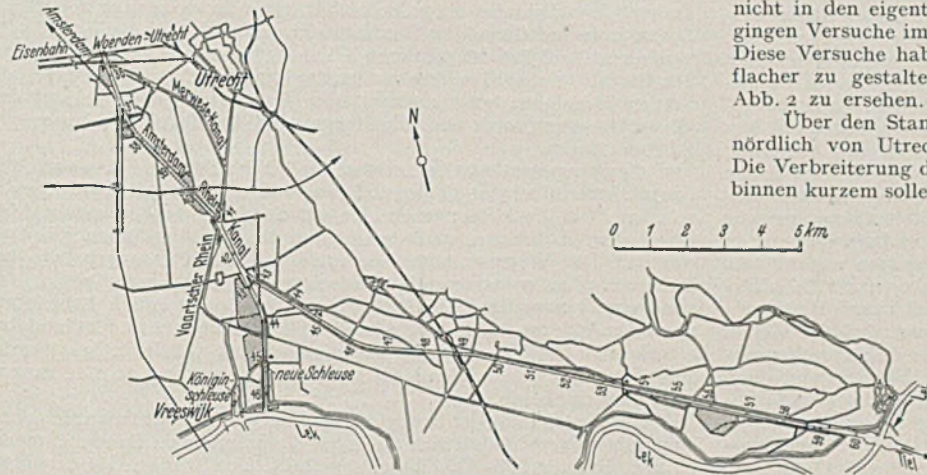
Lageplan des Amsterdam-Rhein-Kanals zwischen Utrecht und dem Lek.
